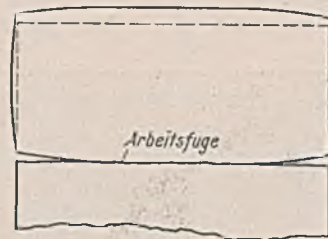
Öffnen der Arbeitsfugen in massigen Betonkörpern durch Verkrümmung des oberen Betonkörpers.
